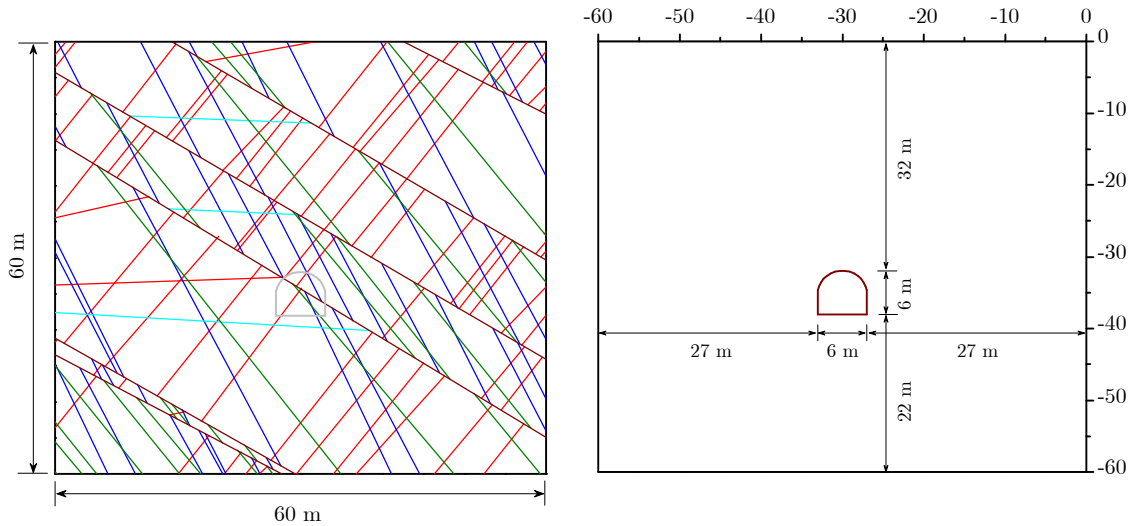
Coupe du massif à travers la section transversale du futur tunnel et position relative du tunnel dans la coupe étudiée.
